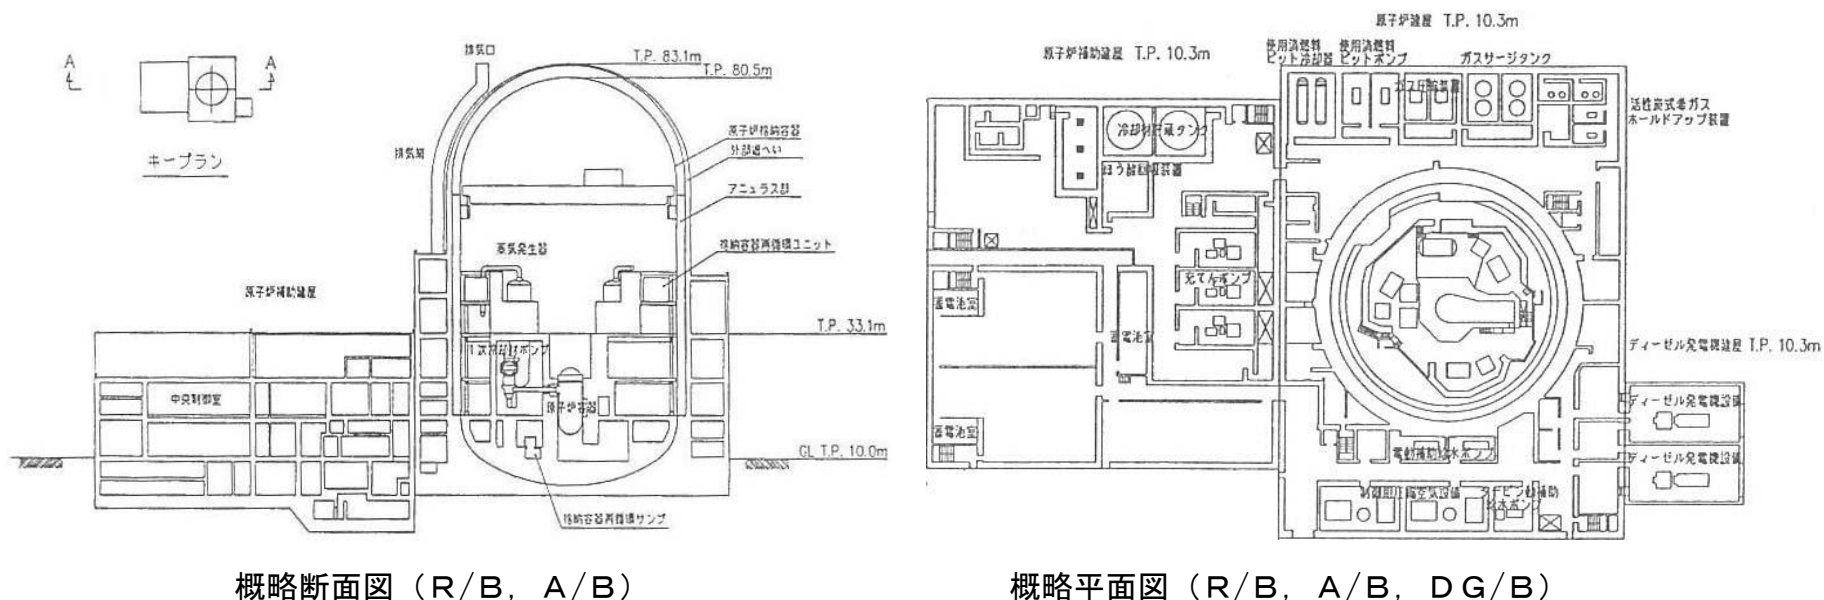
1 竜巻防護施設の概略平面図及び概略断面図
